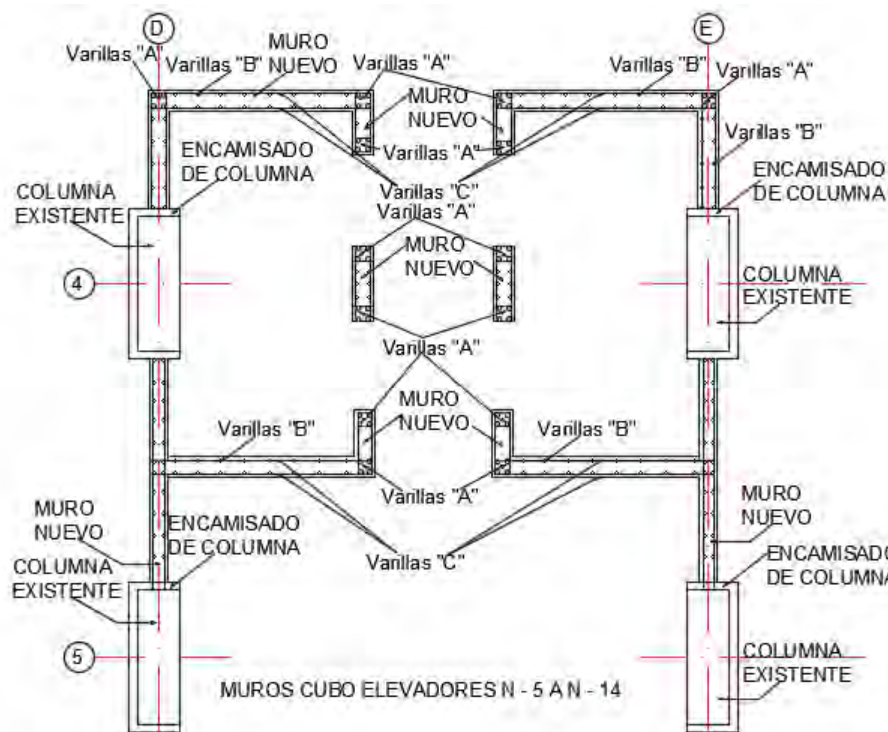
Muros de concreto reforzado en cubo de elevadores del N-5 al N-14
